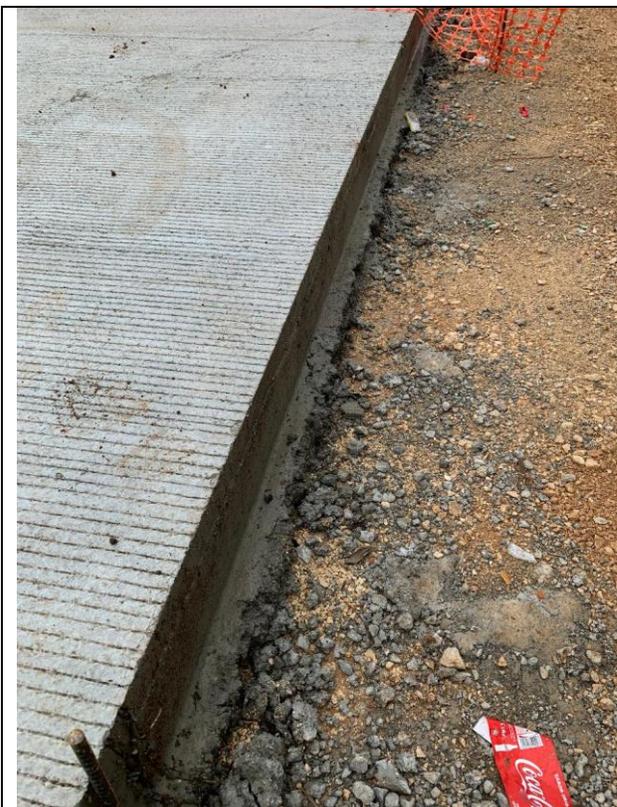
Intercambio Limomal, pavimento de concreto hidráulico en rampa de costado oeste.
